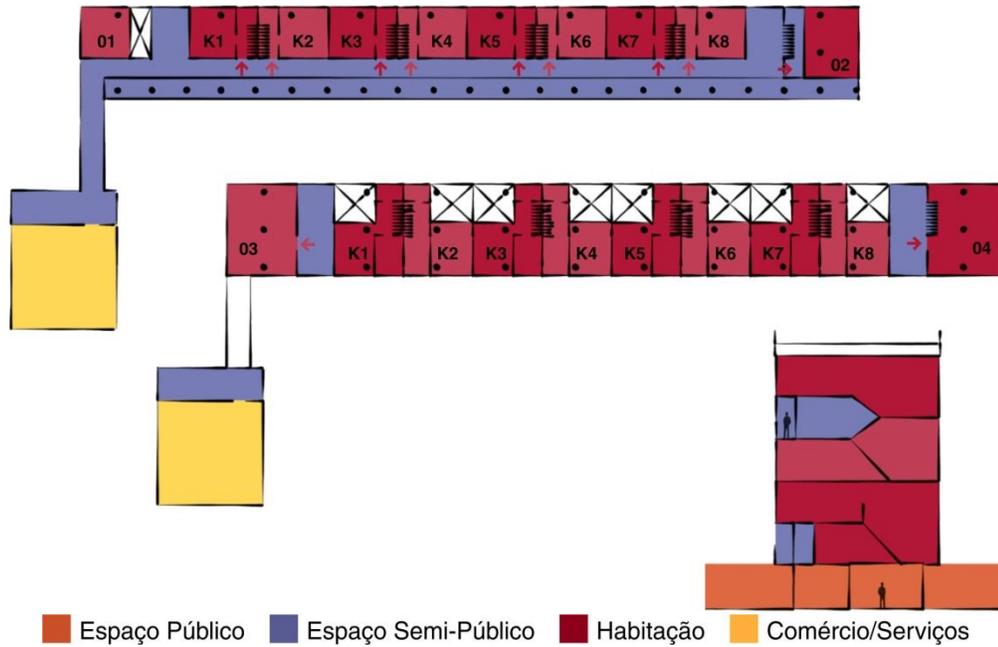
| Narkomfin - Diagramas corte e plantas 1º e 2º pavimentos | Desenho da Autora
